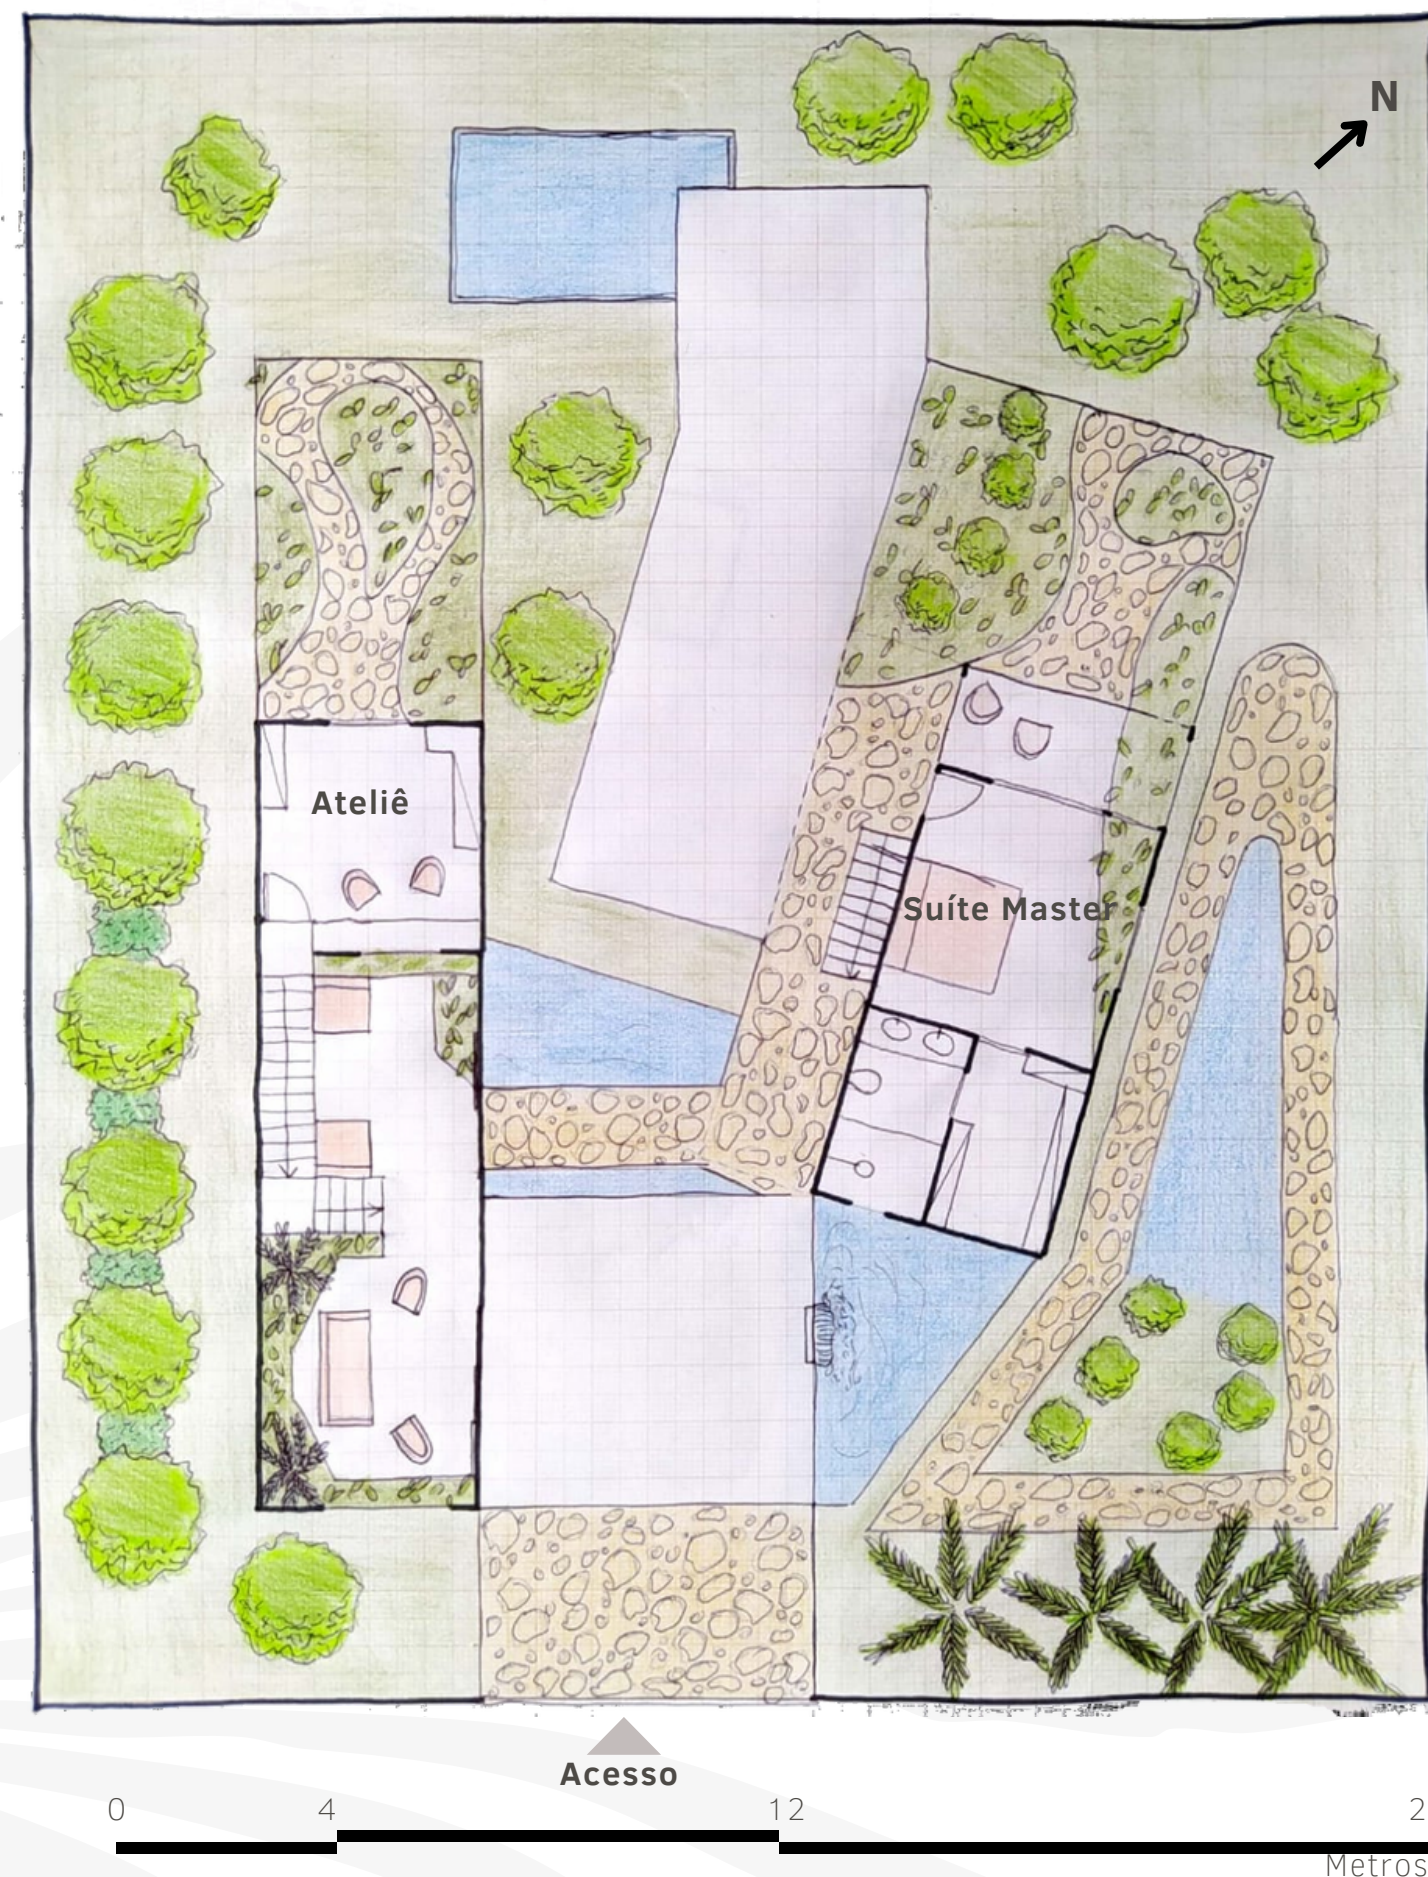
Desenho de Planta baixa .Primeiro Pavimento. Fonte: Elaboração própria da autora.
